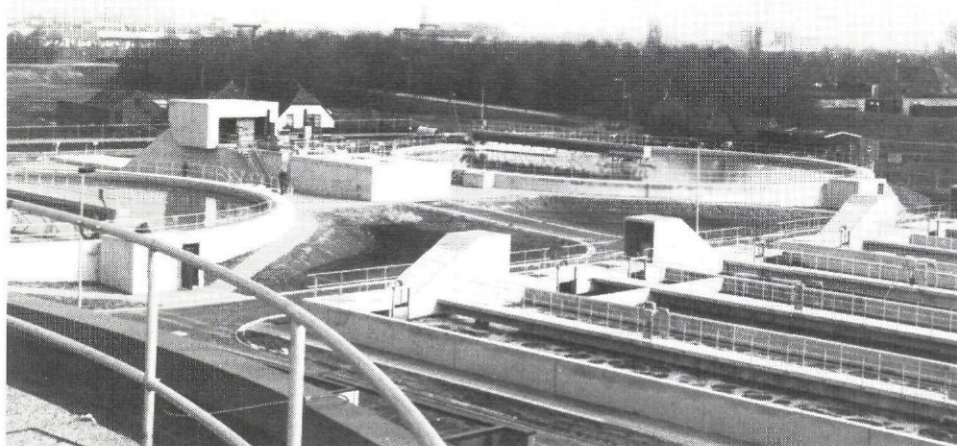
Overzicht van hoofdgemaal, verdeelwerk, voorbezinktanks en beluchtingstanks.
